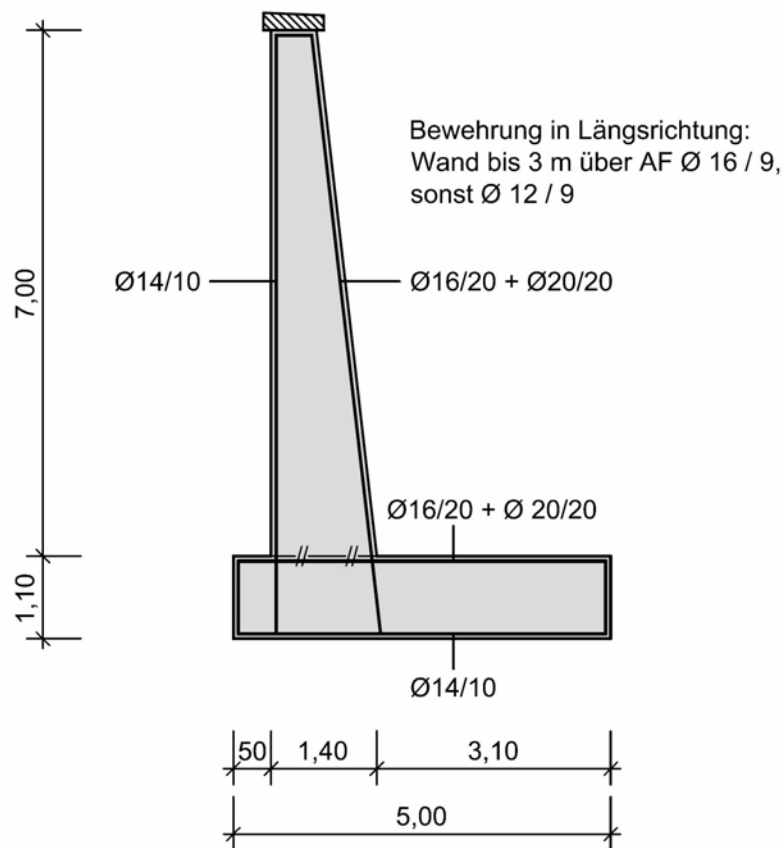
Bauteilabmessungen und erforderliche Bewehrungsquerschnitte
